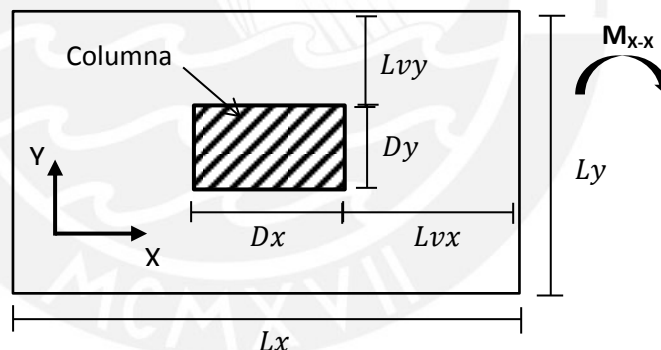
Parámetros de diseño para zapatas aisladas.
